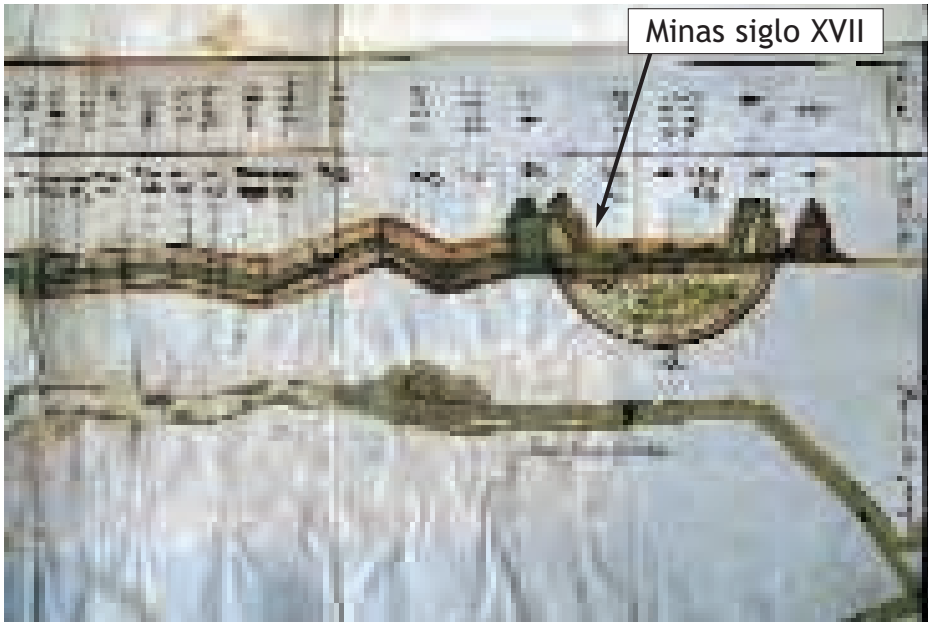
Plano de la conducción s. XVIII desde Sidueña hasta la ciudad (detalle).
